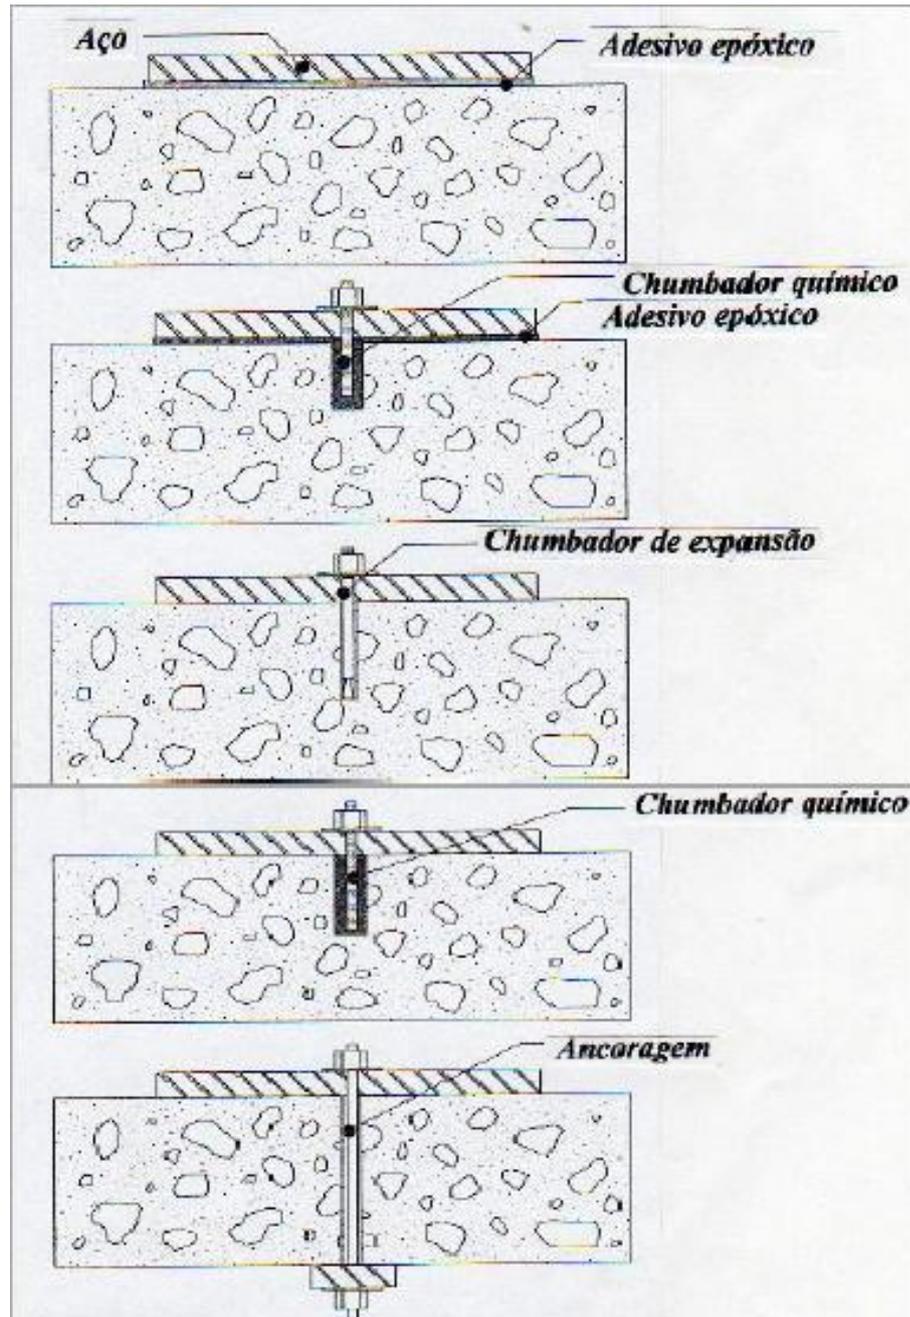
Detalhe esquemático para fixação de chapa metálica.
